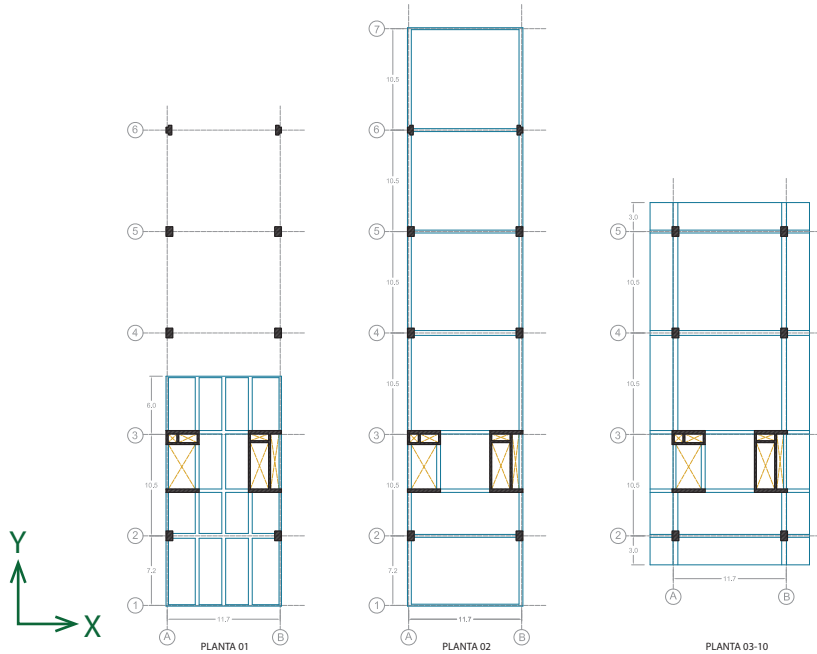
Vista en planta del edificio Jorge Chávez.
